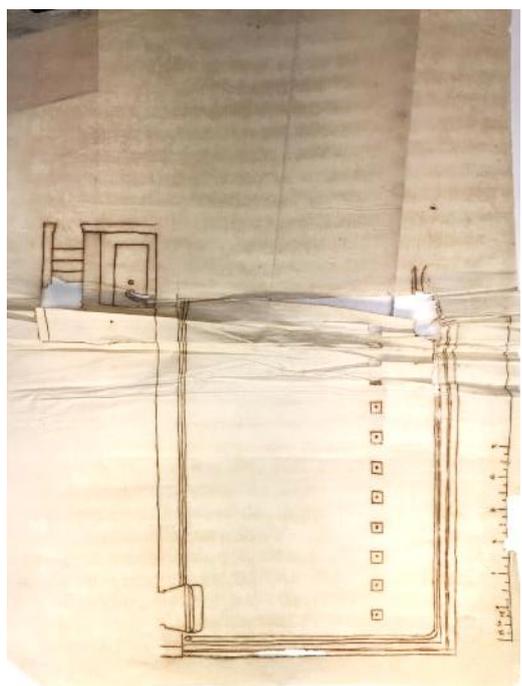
Primer proyecto para la Estufa Tropical, planta. S. MONLEÓN, 1858
